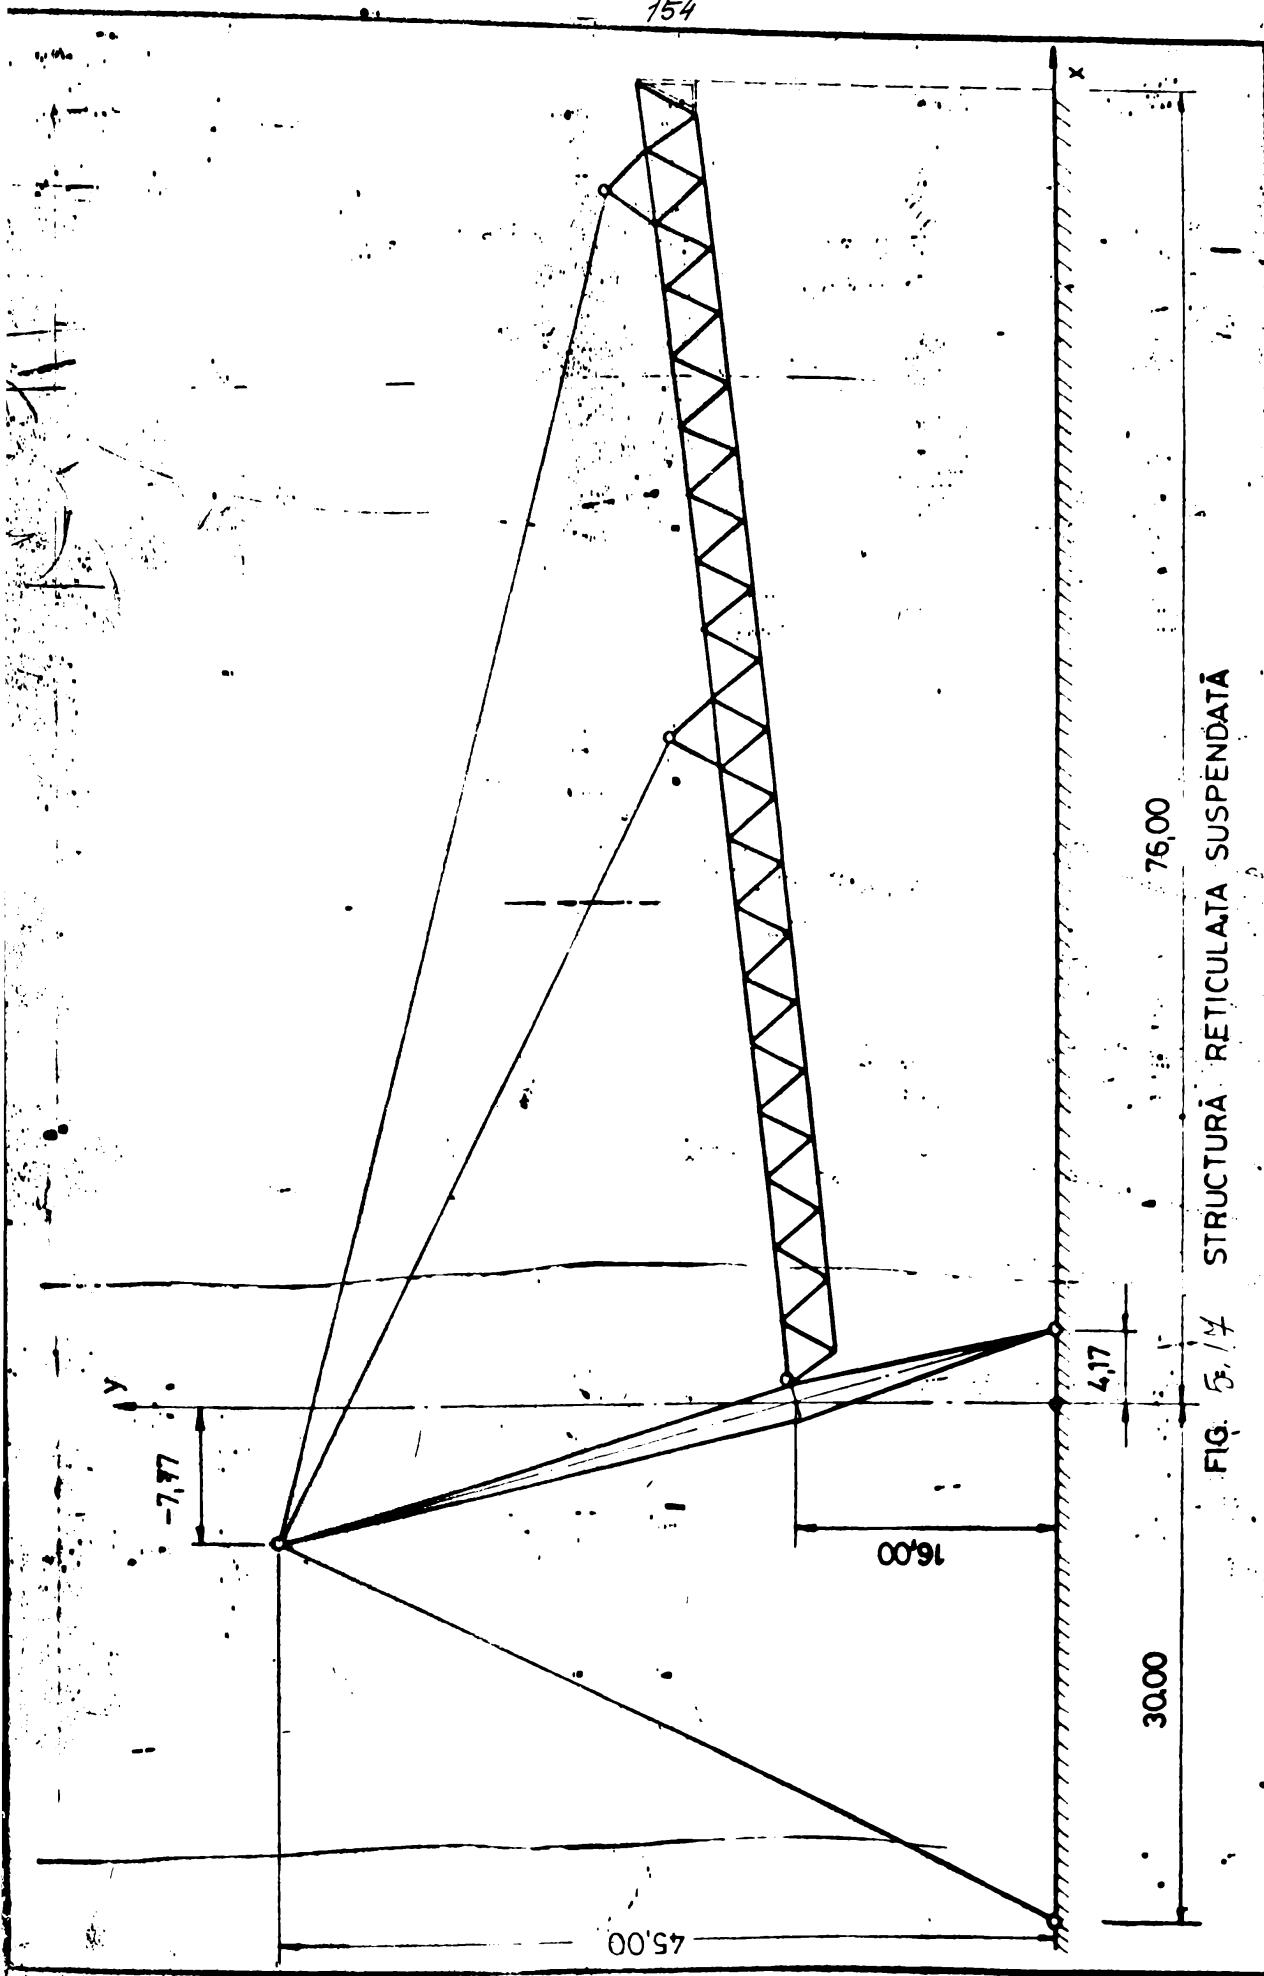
STRUCTURĂ RETICULATĂ SUSPENDATĂ
